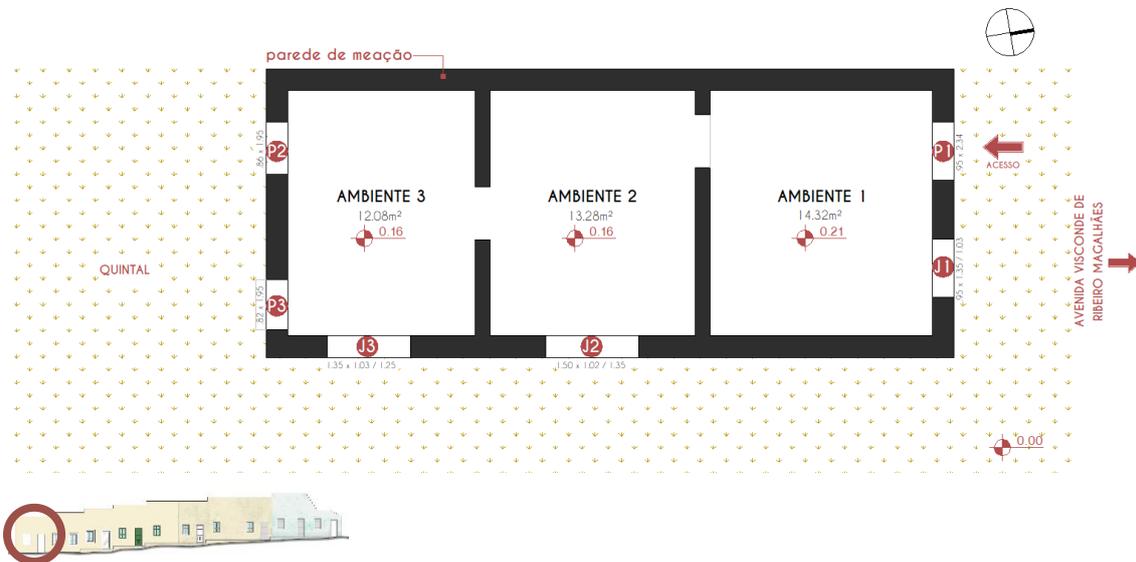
Planta Baixa de unidade do Conjunto Residencial A.
